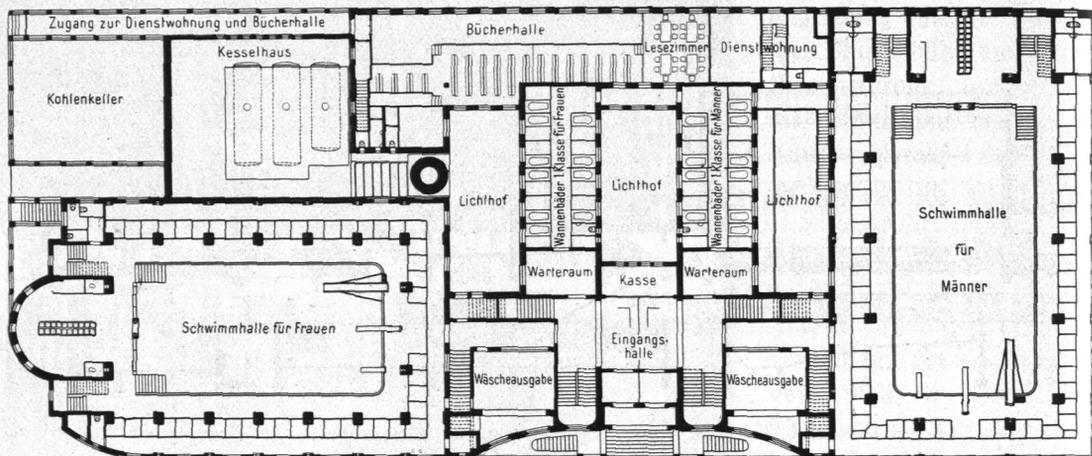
Badeanstalt Hammerbrook, Erdgesch. Grundriß.
